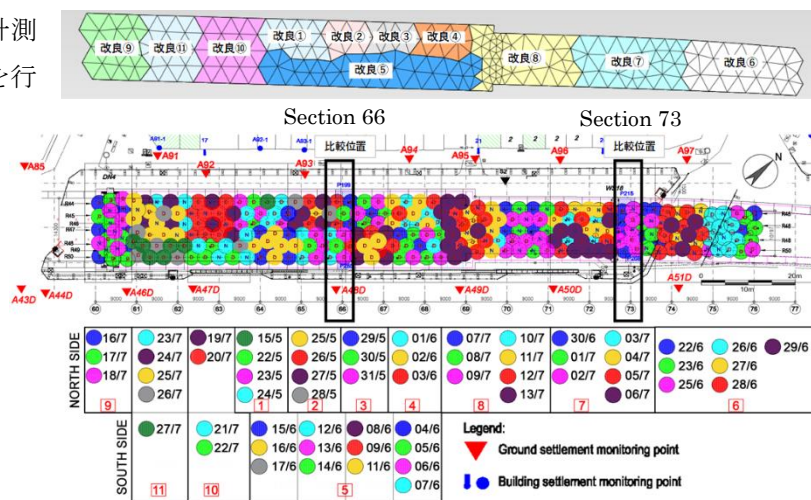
地盤改良 11 ステップの施工時期(下図)と FEM モデル化(上図)
